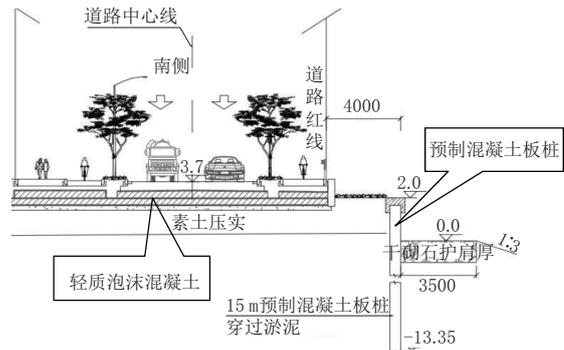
预制混凝土板桩支护+轻质泡沫混凝土路基联合处理设计断面图(单位:mm,标高为m)
